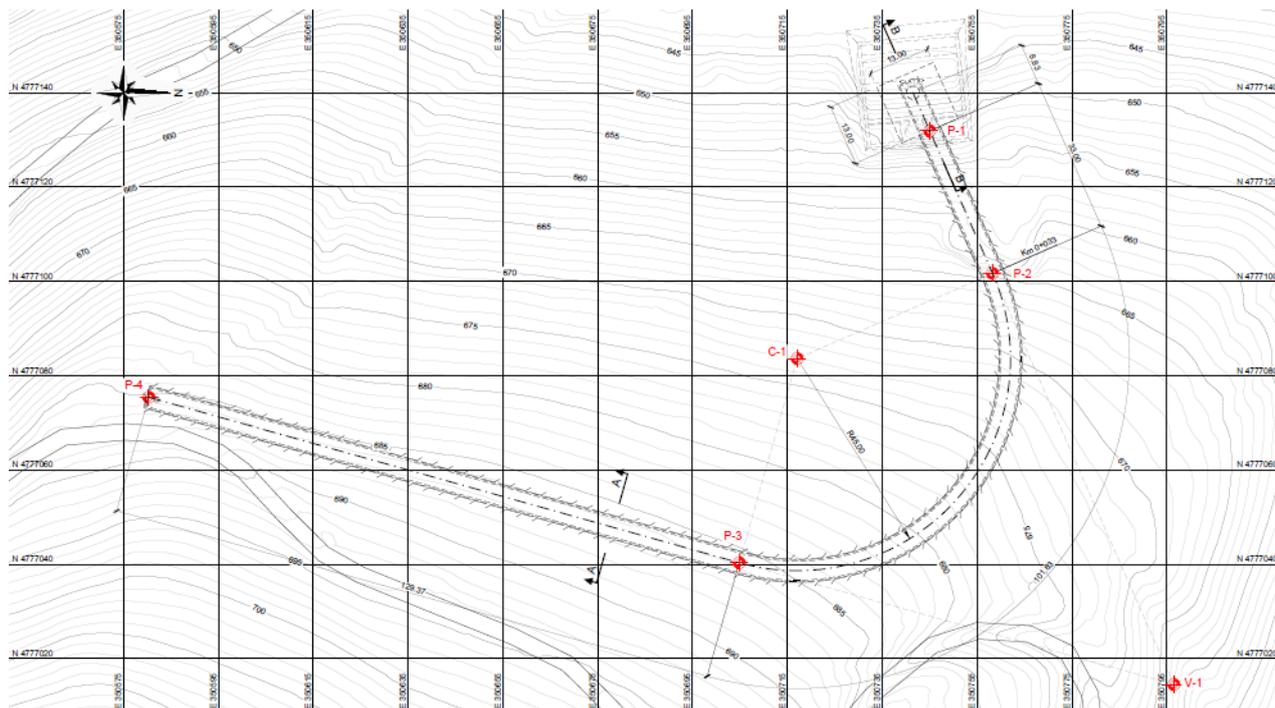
Estratto da Stato di Progetto Estensione Pozzo Piezometrico Fiastrone Pianta, Sezioni, Profili.
